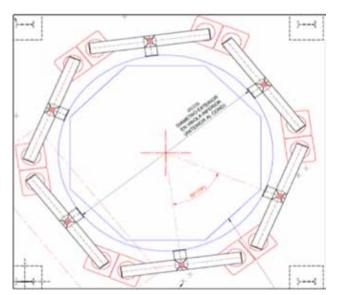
Esquema en planta de la distribución de elementos de elevación.
